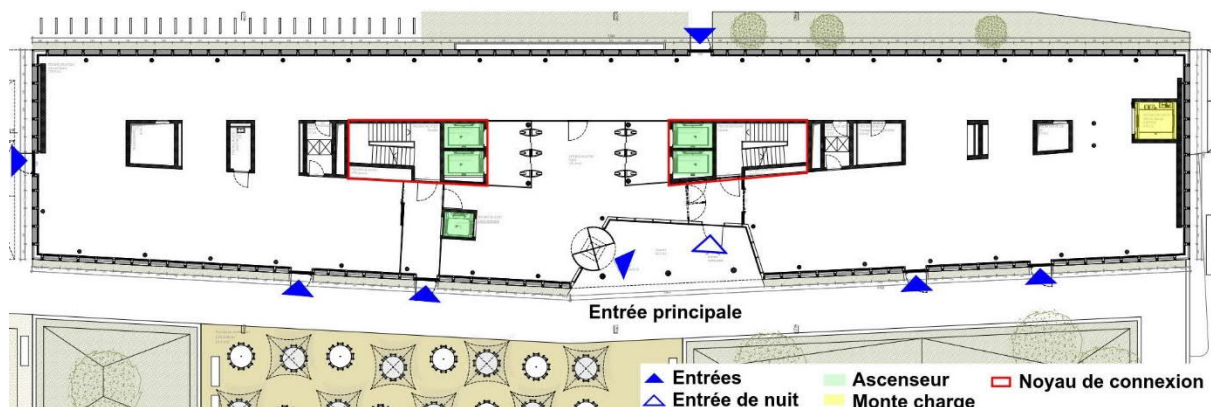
Bâtiment A3 - Plan du rez-de-chaussée
